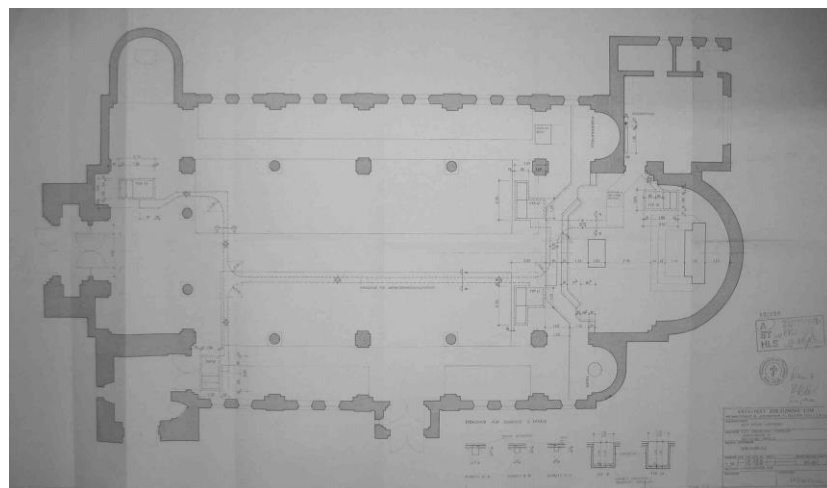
Grundriss, Architekt Bob Clemens Link, Bochum, 18.04.1984
